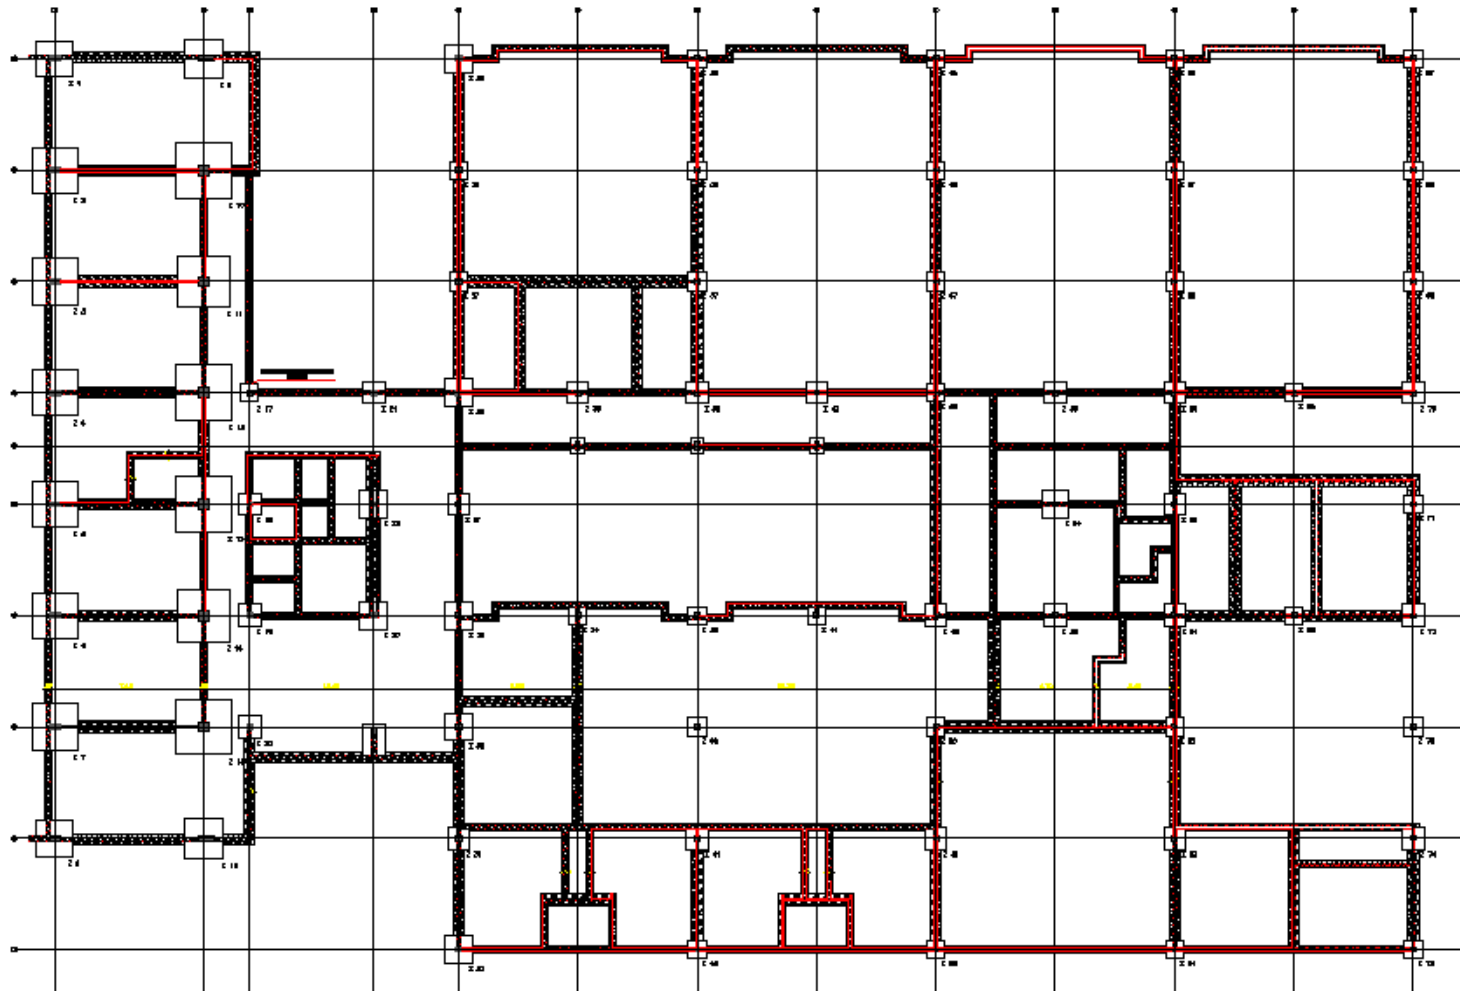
Cimentación Cenigraf, Estructuras 1 y 2
